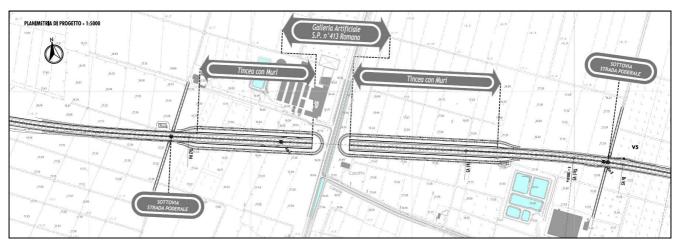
STRALCIO PLANIMETRICO
